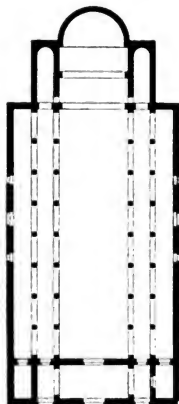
Basilika in Suweda. Grundriss.
